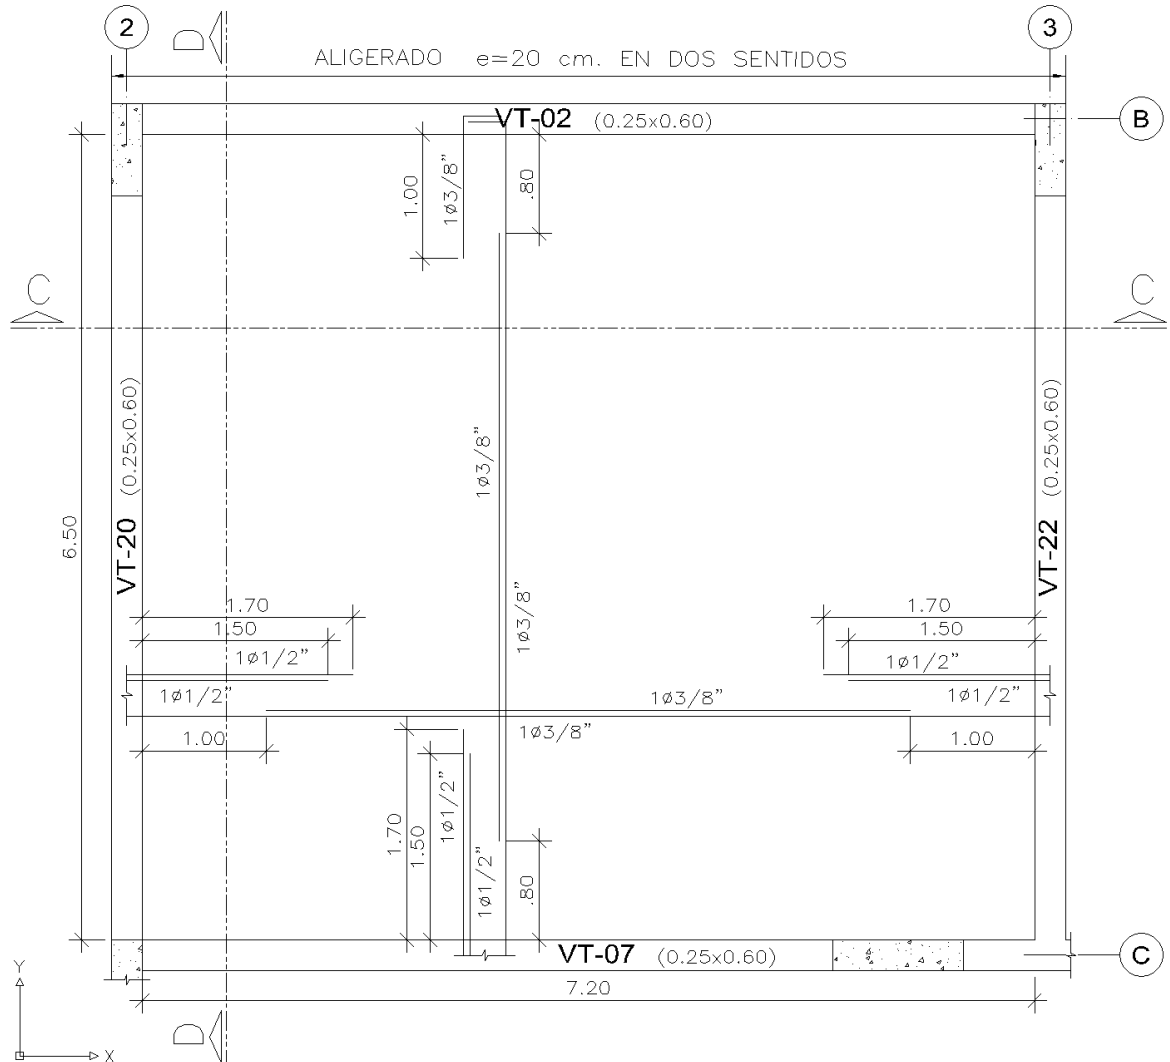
Vista en Planta del Paño de Losa Aligerada Bidireccional, Comprendida entre los *Ejes 2 – 3/B – C*, del 2do Piso del Proyecto “Vivienda Multifamiliar Tudela y Varela”.
